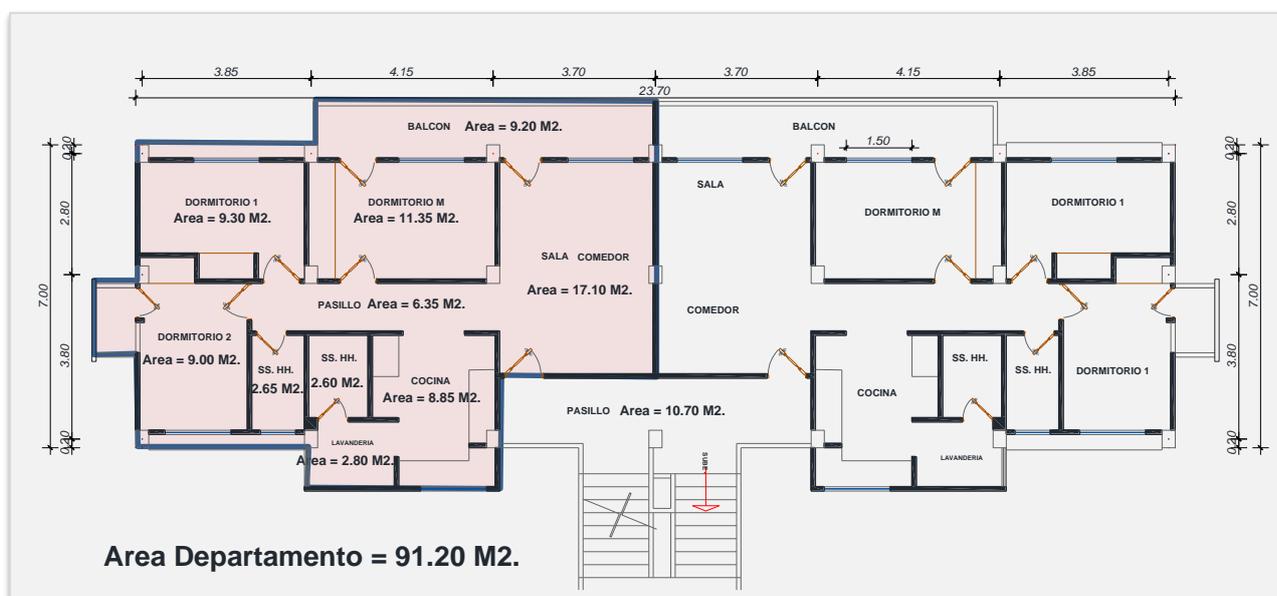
Área de cada espacio. Planta tipo, modelo lineal.
